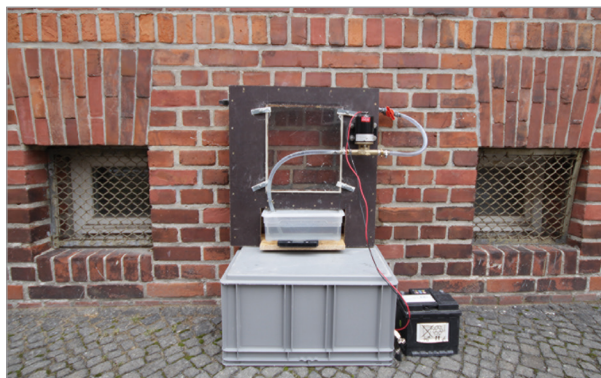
Das Wasseraufnahmemessgerät an einer Sichtmauerwerkfassade
